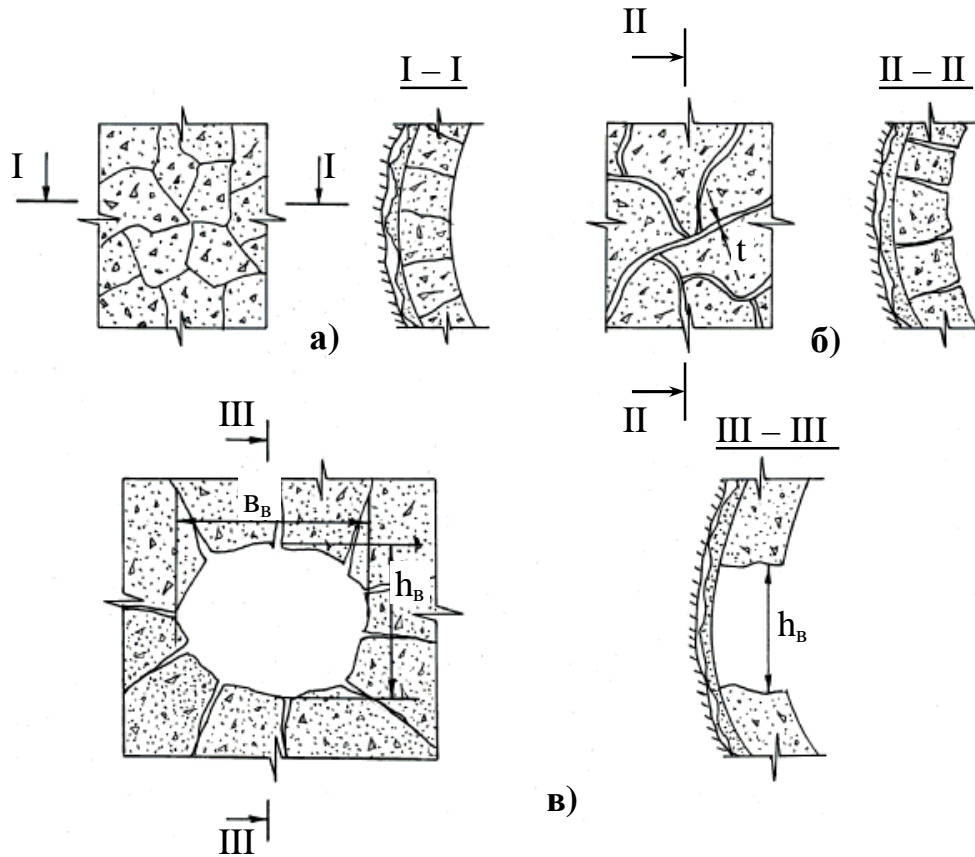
Стадії порушення бетонного кріплення:
